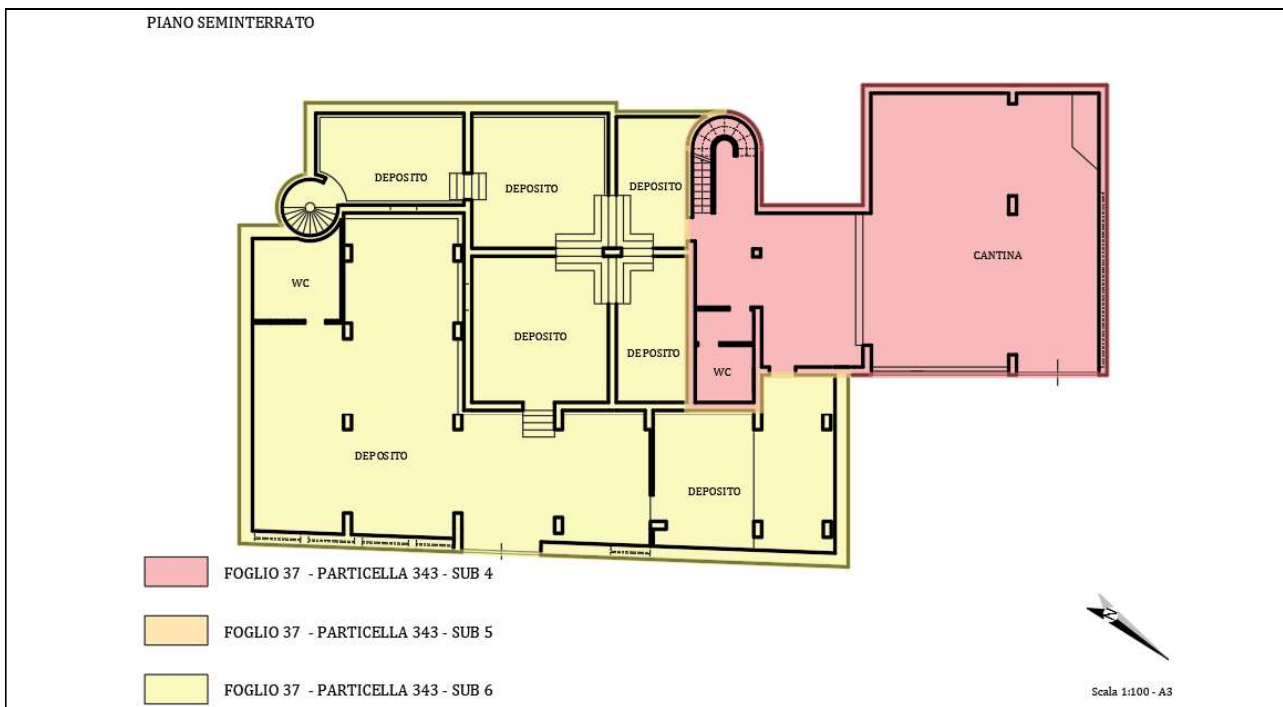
Planimetria dell'immobile – Piano seminterrato
